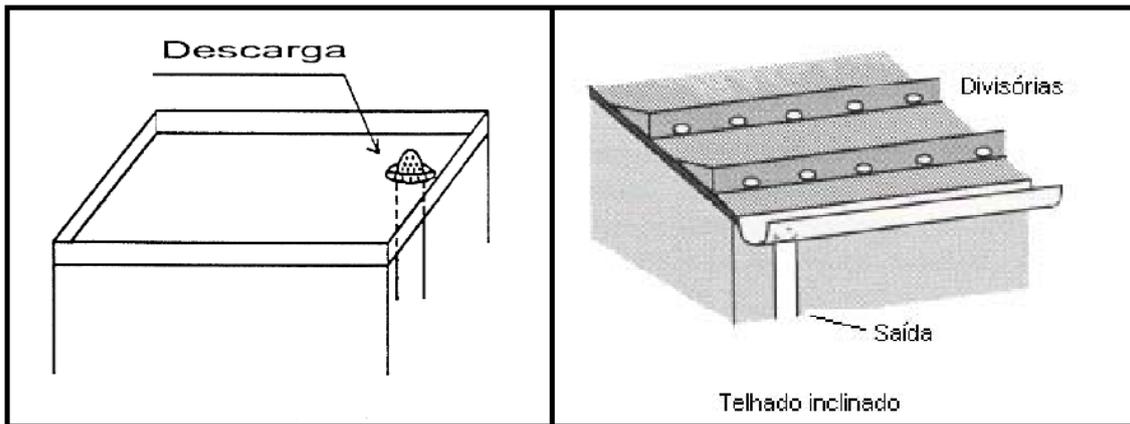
Esquema de um telhado armazenador plano (CASTRO, 2002 apud BRITO, 2006) e inclinado (CETE DU SUDE-OUEST, 2003 apud BRITO, 2006).
